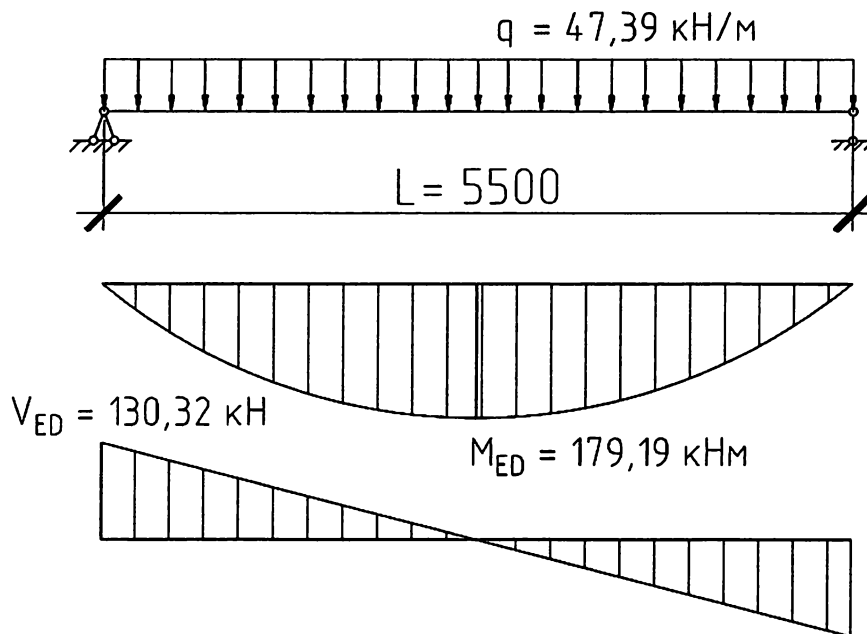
Расчетная схема балки, эпюры внутренних сил
